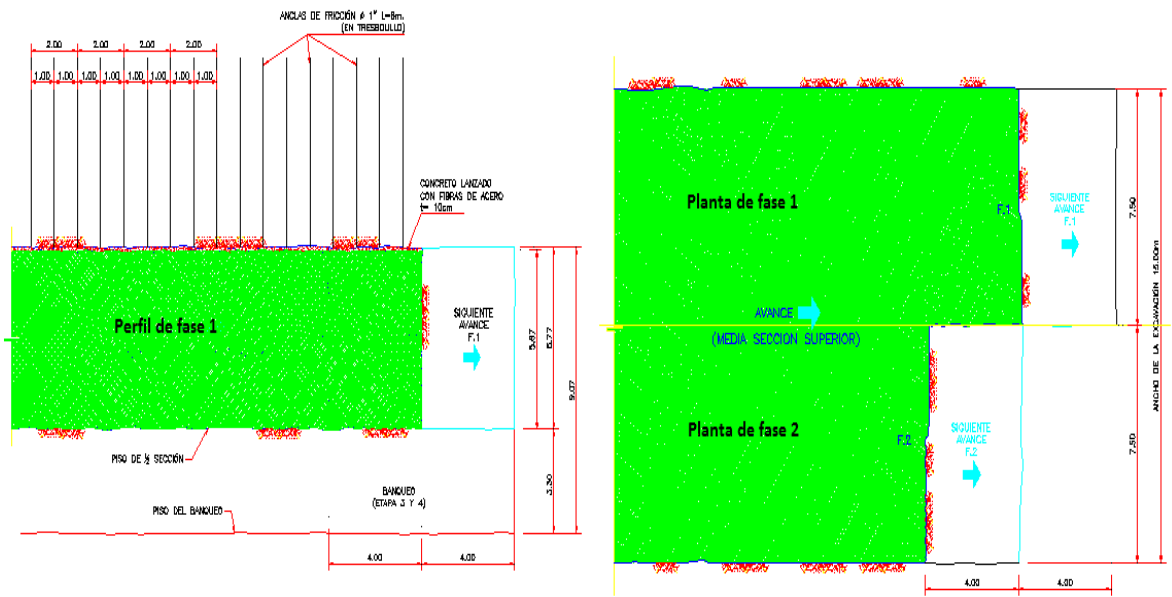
Perfil y planta del avance de la excavación en Condición Geotécnica “C(+)”
